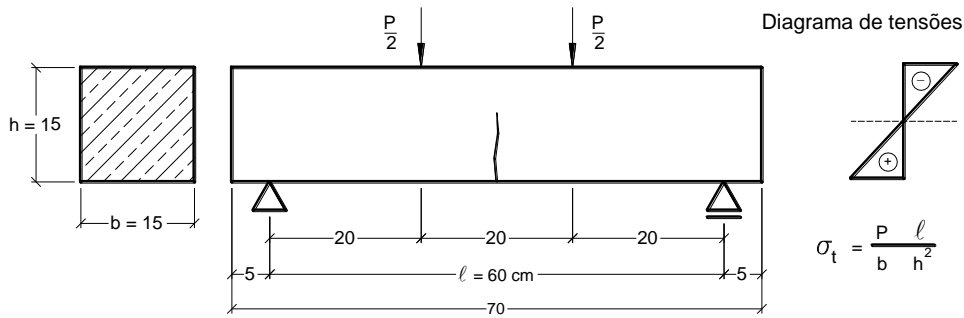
Resistência do concreto à tração determinada por ensaio de tração na flexão.
